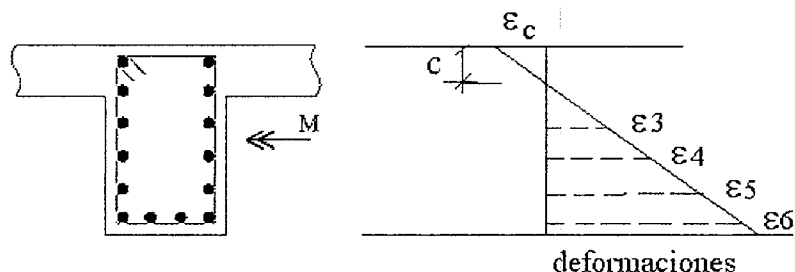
Sección con refuerzo distribuido en el alma.
